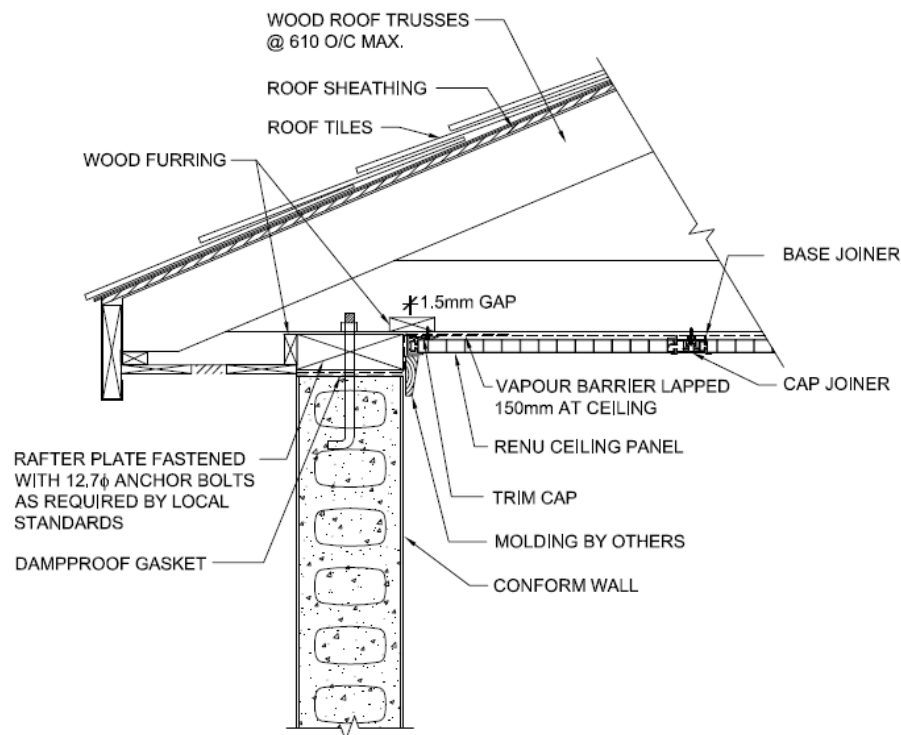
Pormenor de ligação painel de teto com parede de cofragem de PVC [120]
